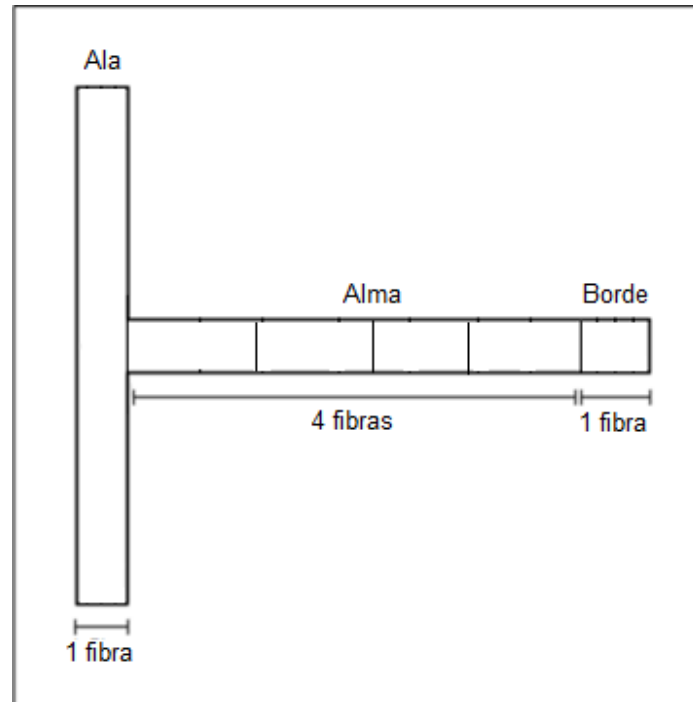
Discretización de la sección del muro en fibras MVLEM.
